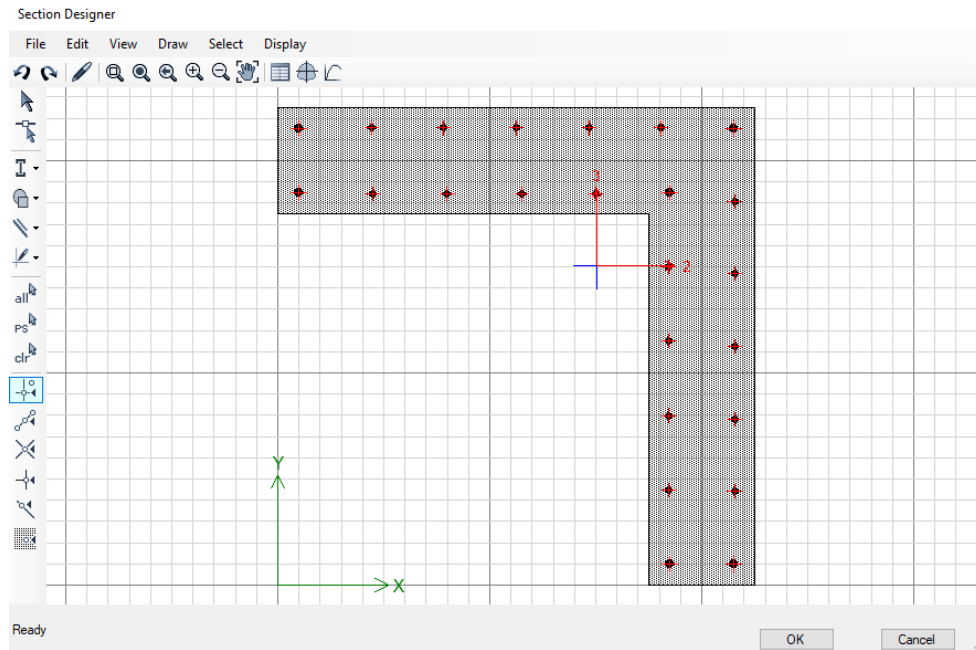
A: Sección de placas en L. Fuente: elaboración propia.
